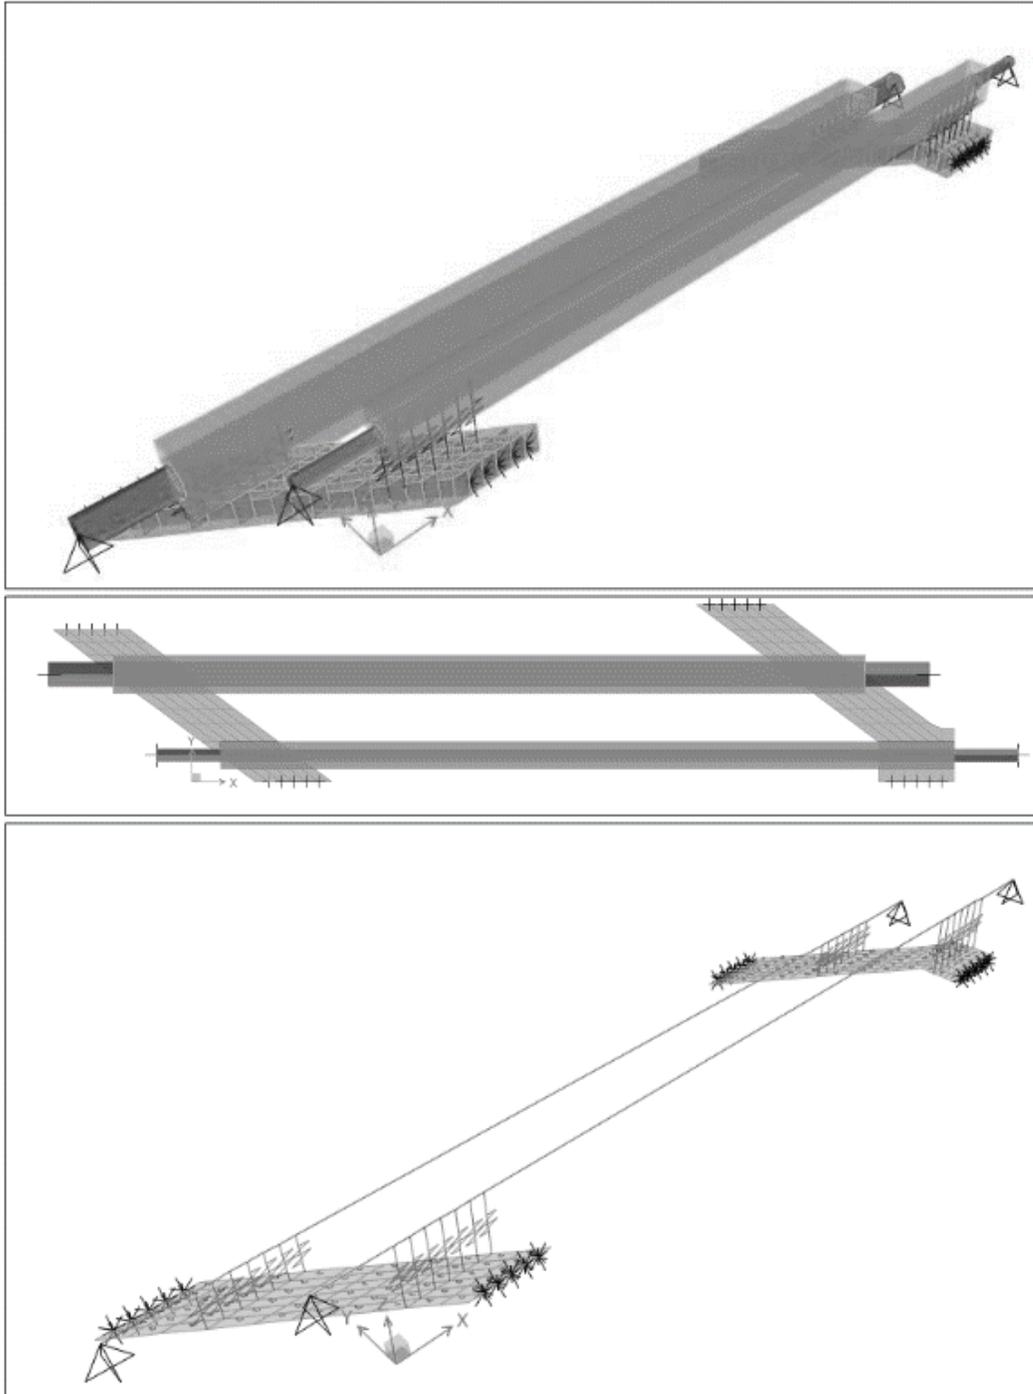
Estructura de Cuelgue. Viga para tubería DN 900mm y DN 450mm. Modelado en SAP 2000.
